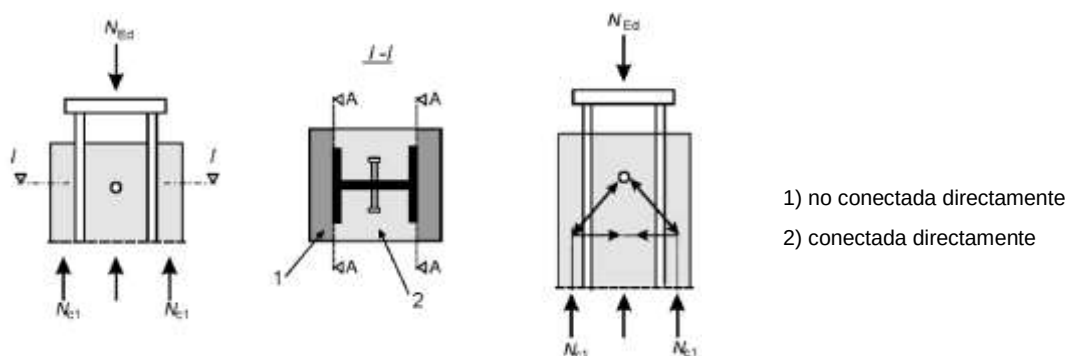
Superficies de hormigón conectadas directa e indirectamente para el dimensionamiento de la armadura transversal
